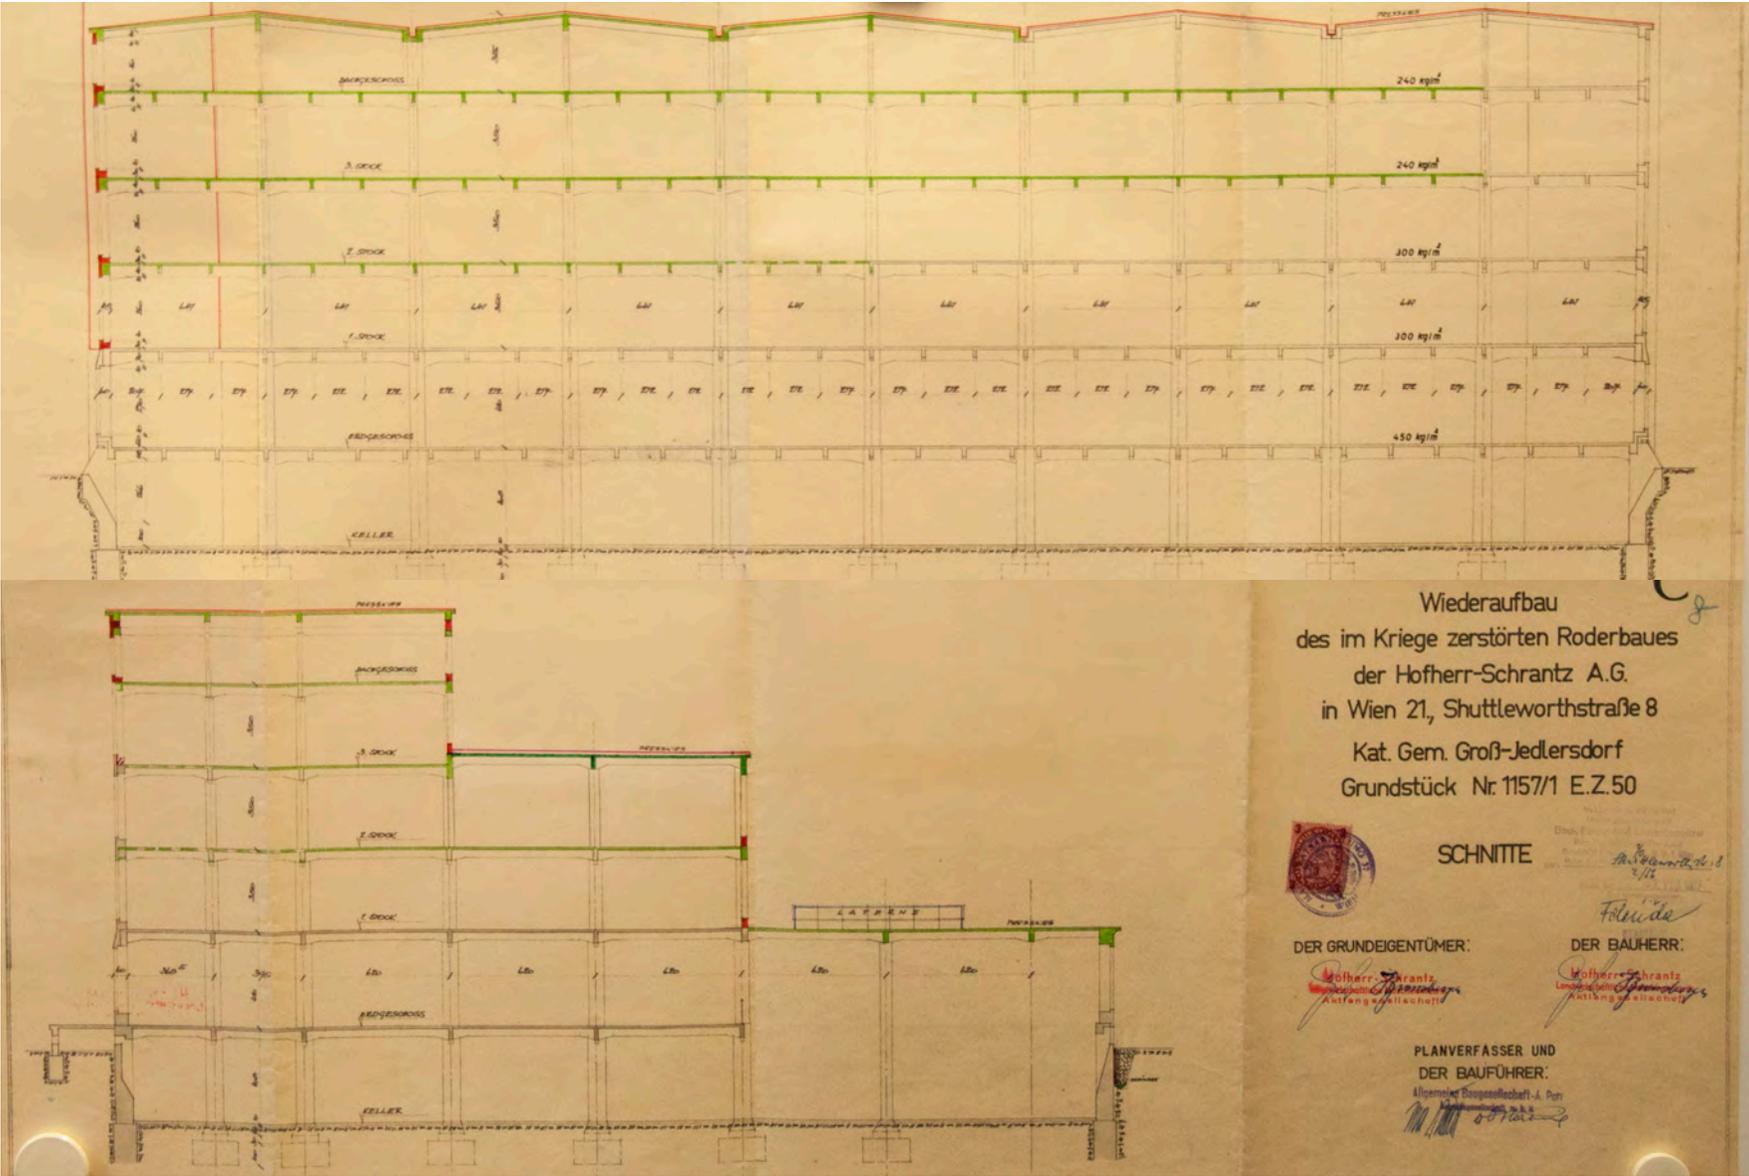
Bauphasenplan 1957: Längs- und Querschnitt des Maschinenmagazins
